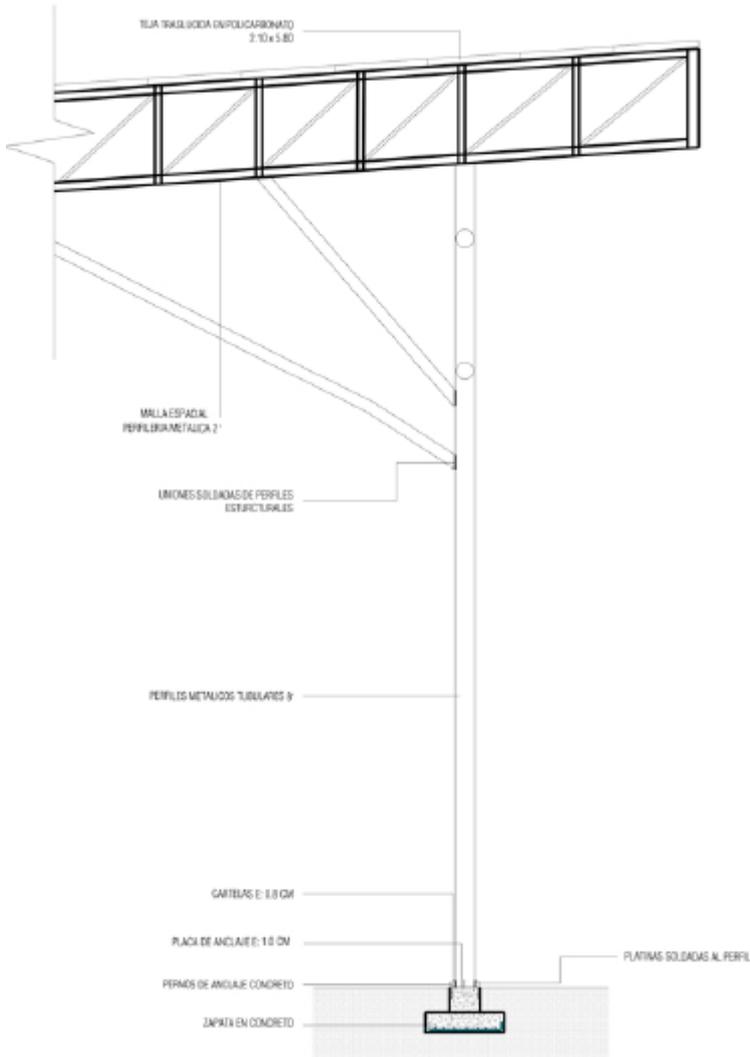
Detalle estructura cubierta traslucida. Fuente: Elaboración propia
